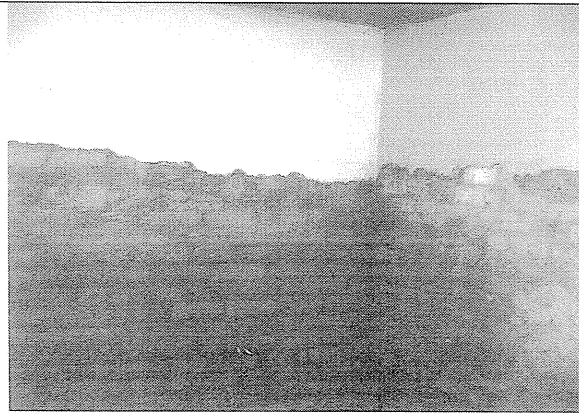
Humedad y daño en acabados de muros de la zona posterior.
